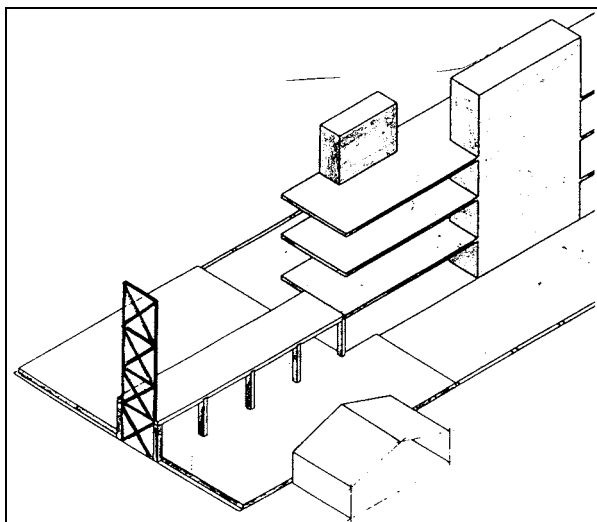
Tragstruktur des Kopfteils mit dem Fachwerk und dem untersten C-Träger
